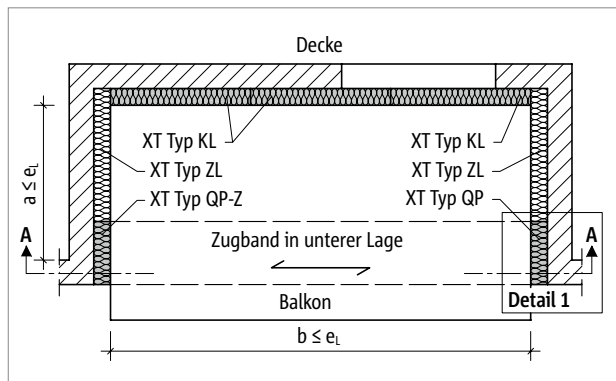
Schöck Isokorb® XT Typ QP-Z, QP: Grundriss Loggia
